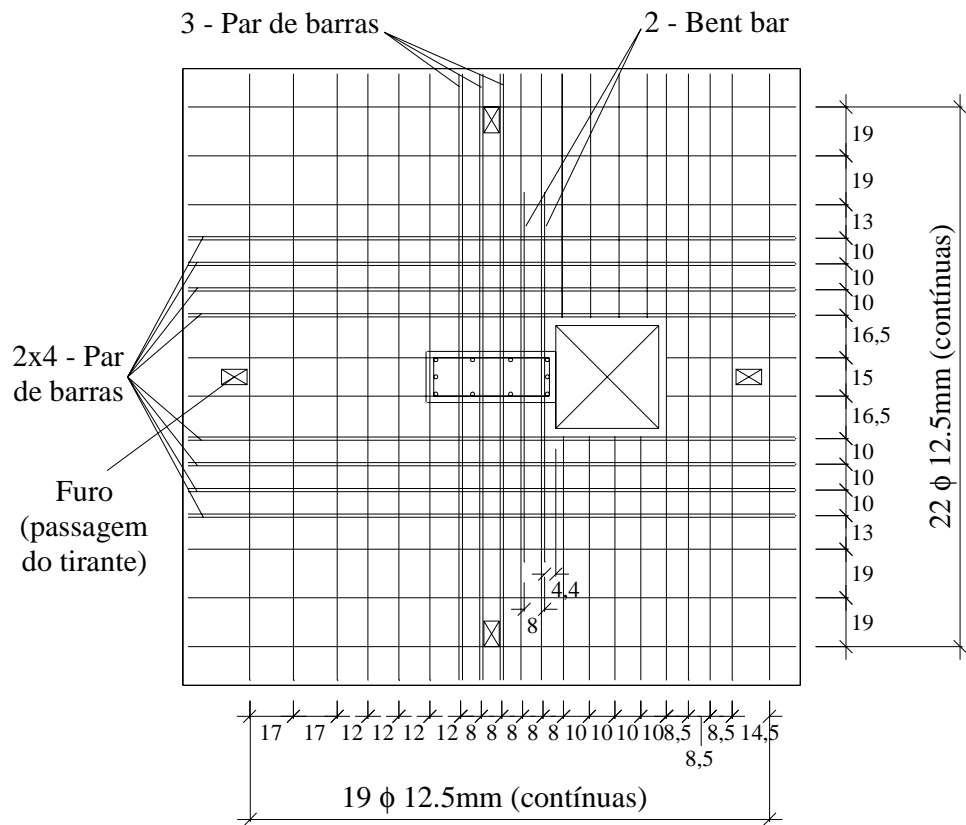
Posicionamento da armadura de cisalhamento da laje L5 (cm)
